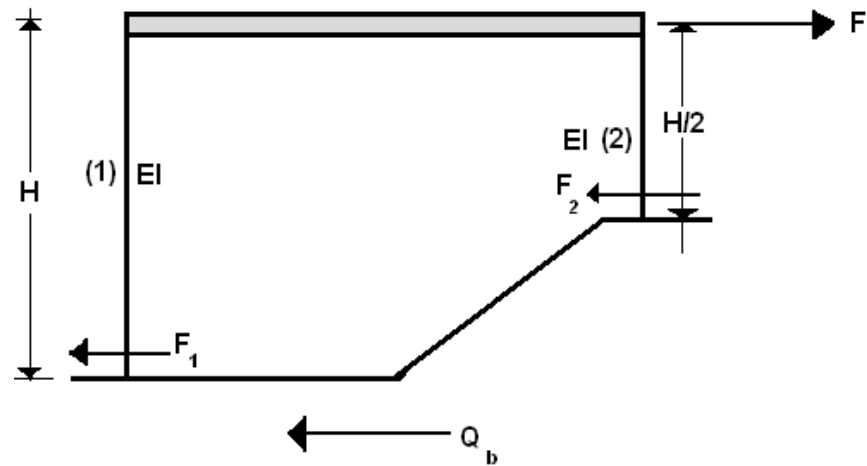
Marco plano con columnas de diferente rigidez al corte.
